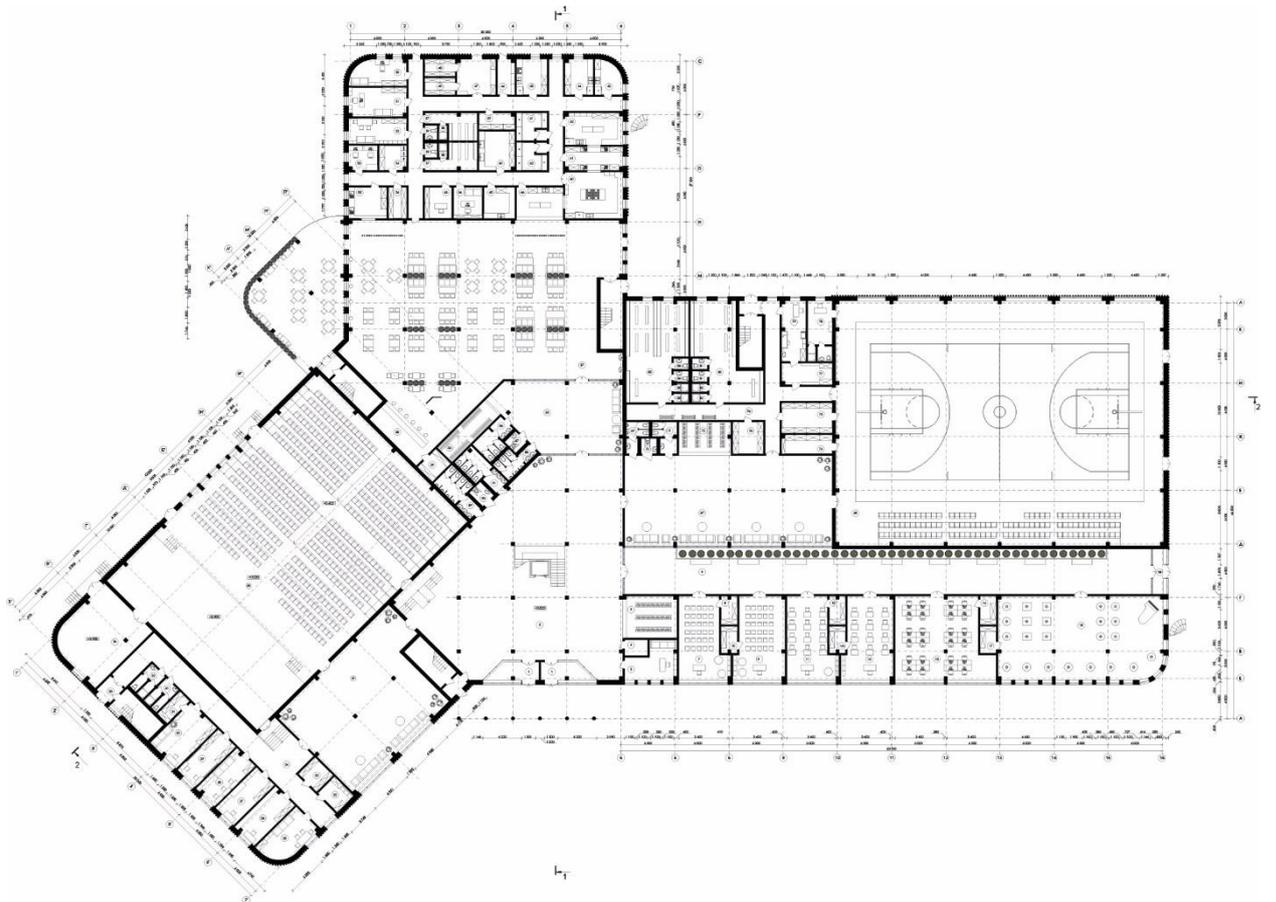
Схема розташування несучих конструкцій будівлі (1-й поверх)
